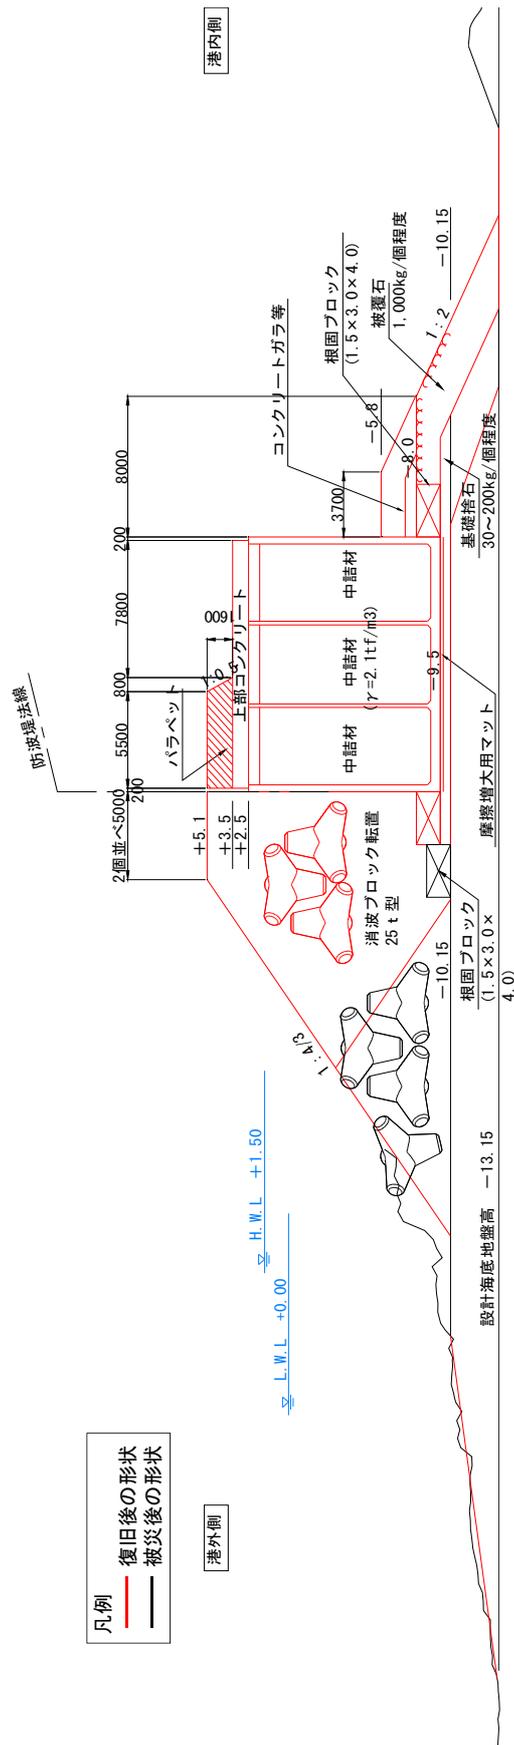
No.1 沖防波堤の断面図 A-1-5 区 (復旧後)
